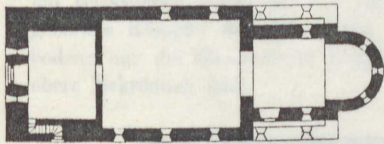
Neuendorf; Kirche, Grundriss vor dem Ausbau. 1:500.
